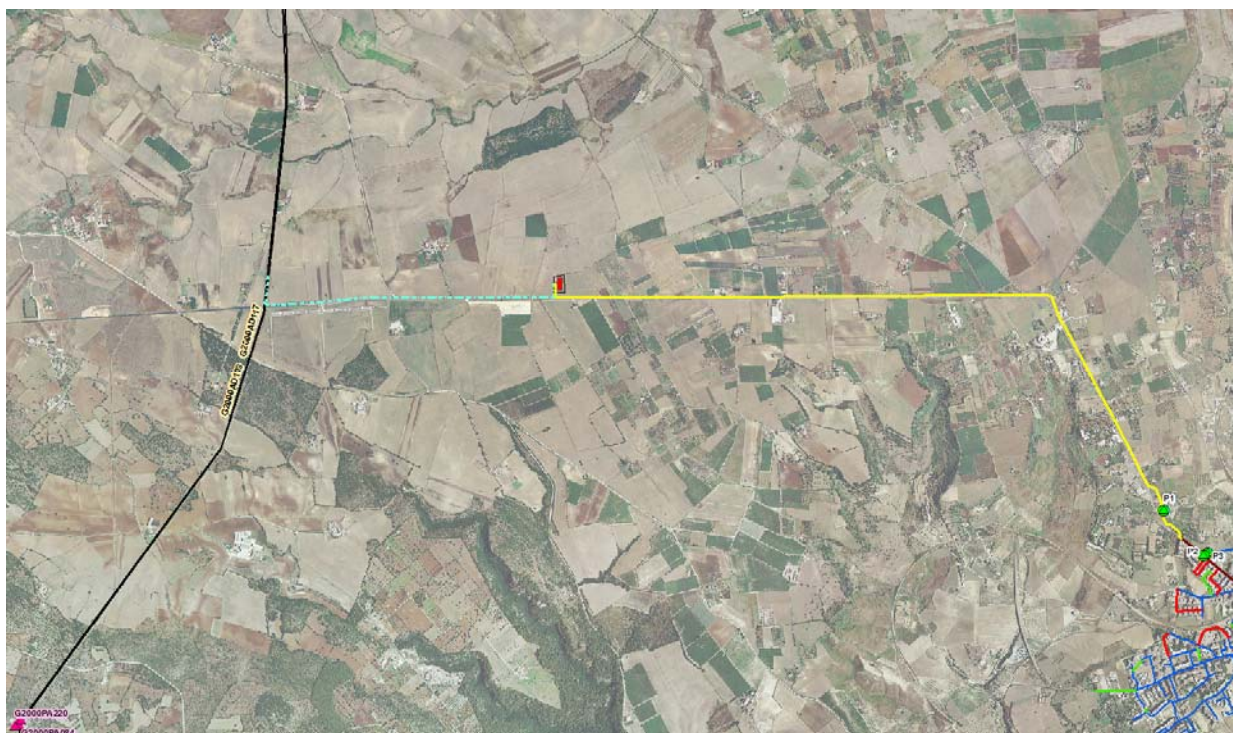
Interventi di progetto della rete idrica di adduzione: in giallo la suburbana.
